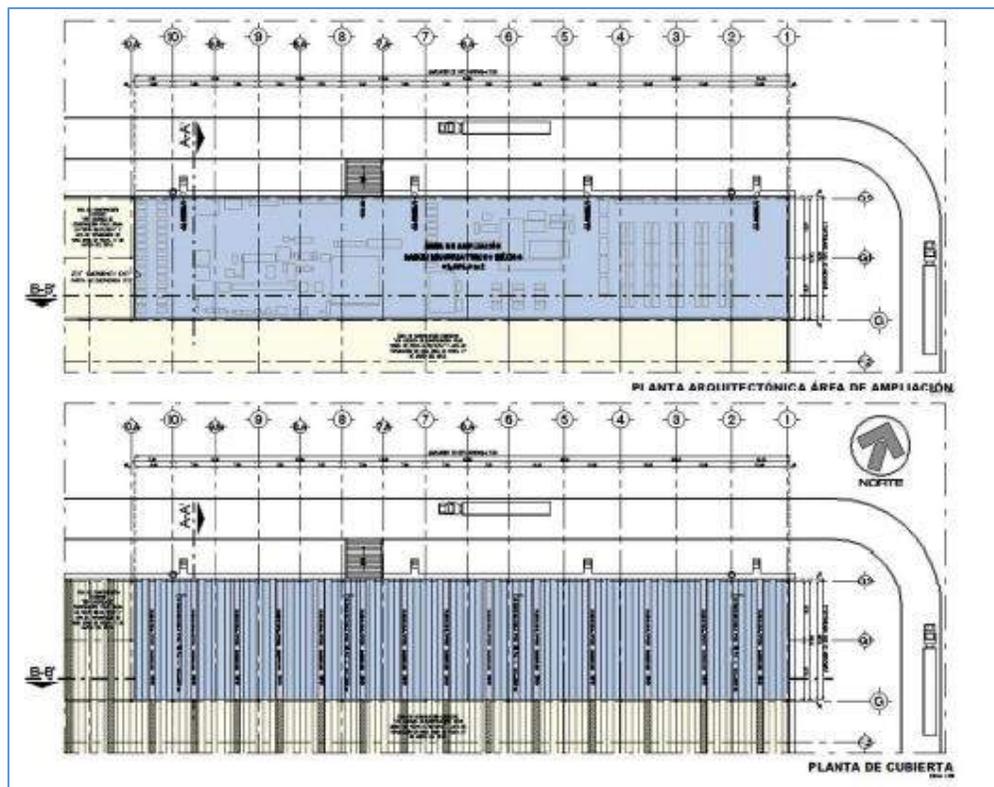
Planta Arquitectónica de la Ampliación de la Nave Industrial
